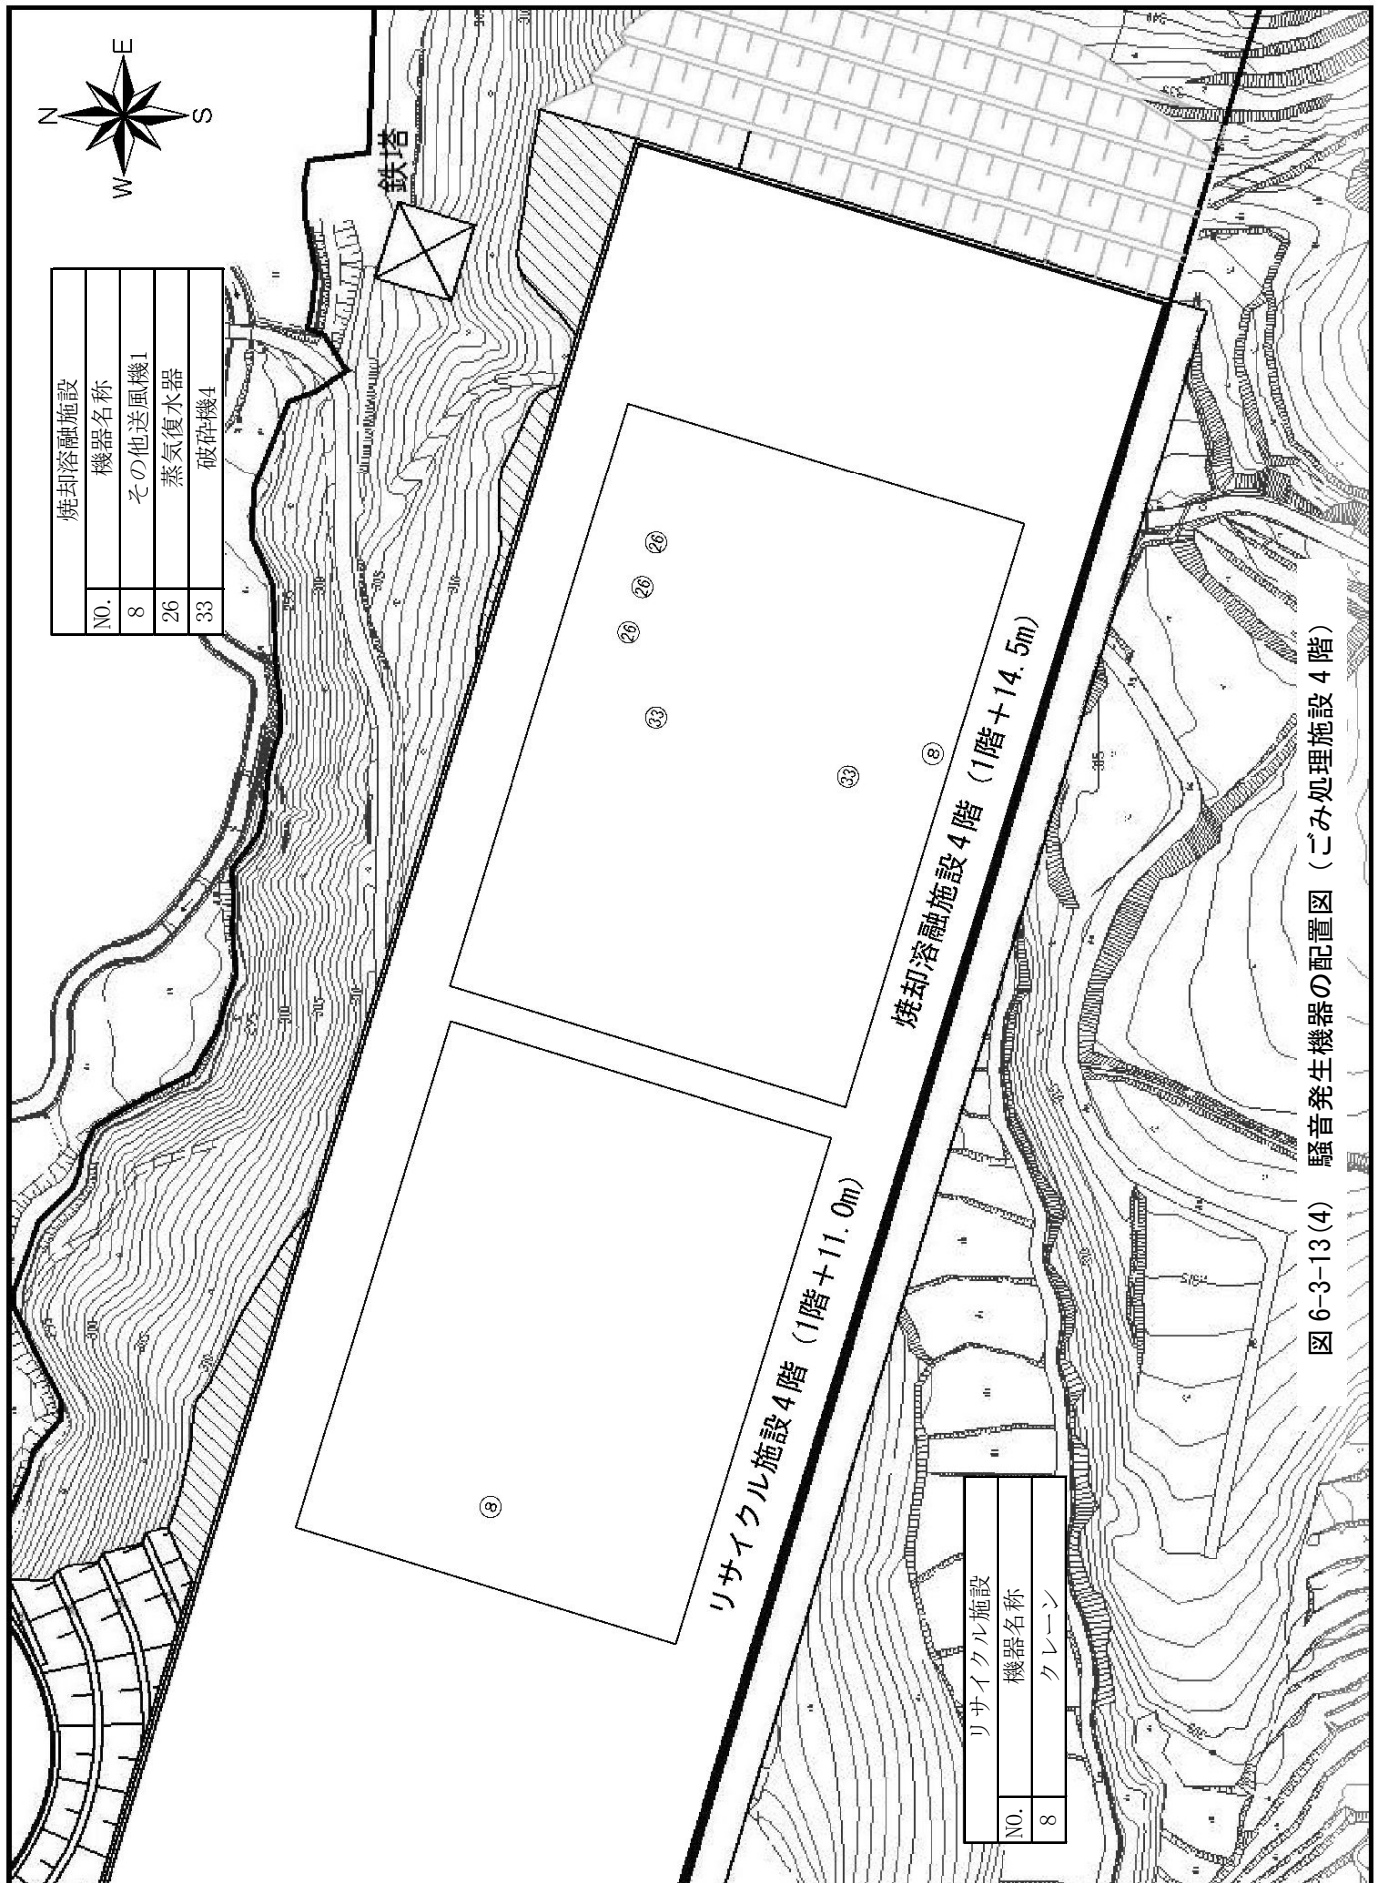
(4) 騒音発生機器の配置図 (ごみ処理施設 4 階)
